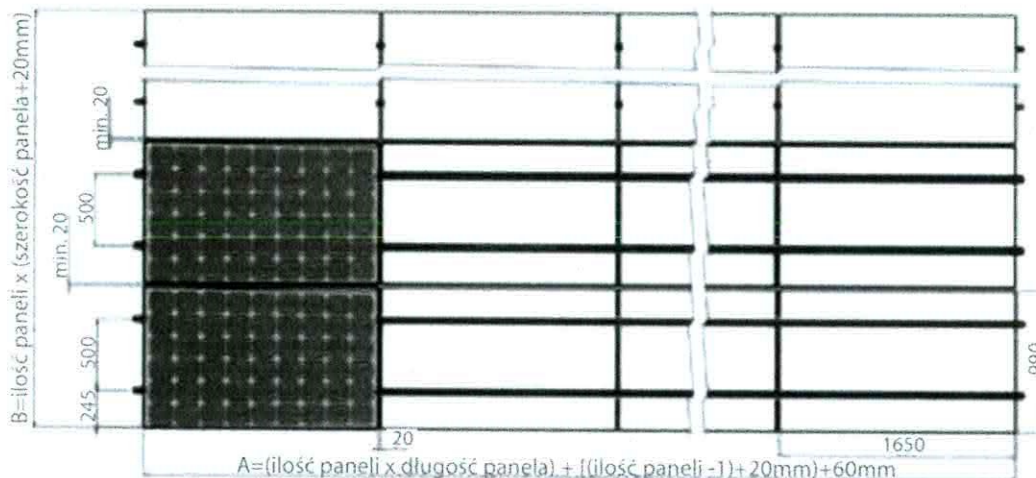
Przykładowy sposób wykonania i montażu na konstrukcjach naziemnych
